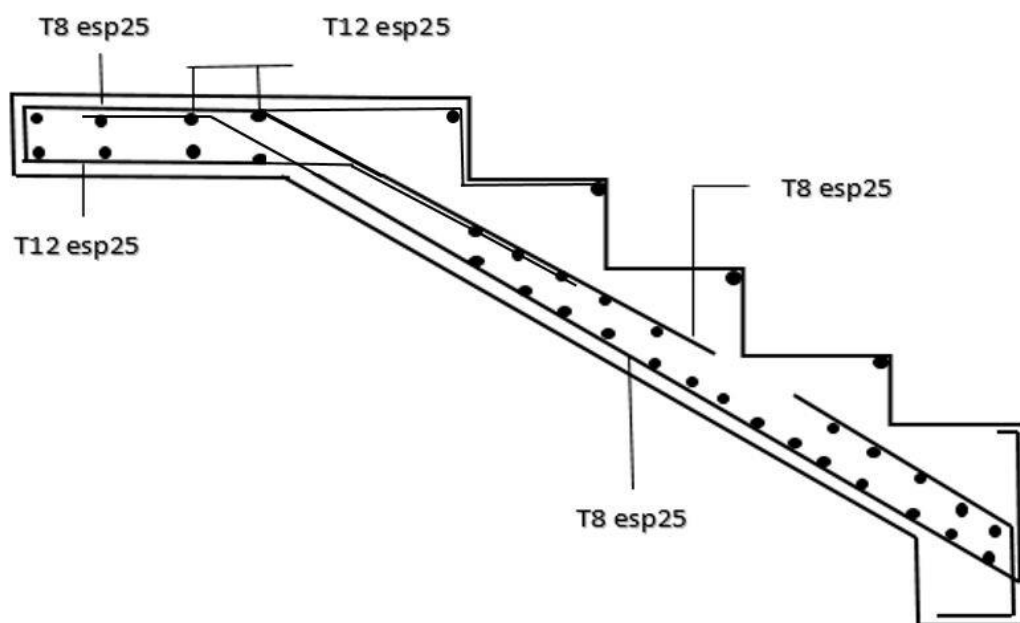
ferrailage de l'escalier volé 2 et 3.
